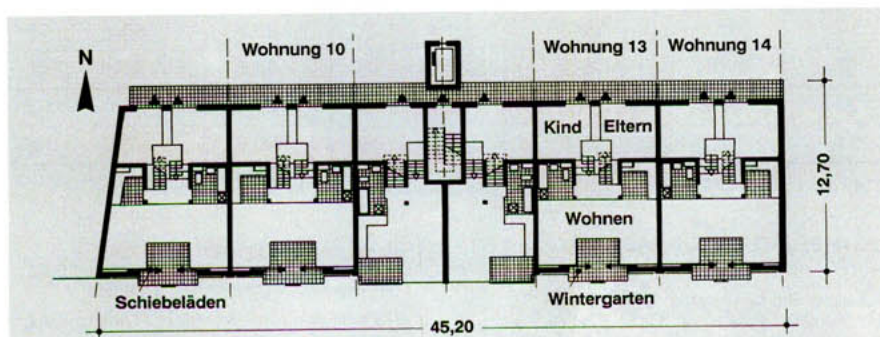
Darstellung des Grundrisses der eingeschossigen Solarwohnung.
